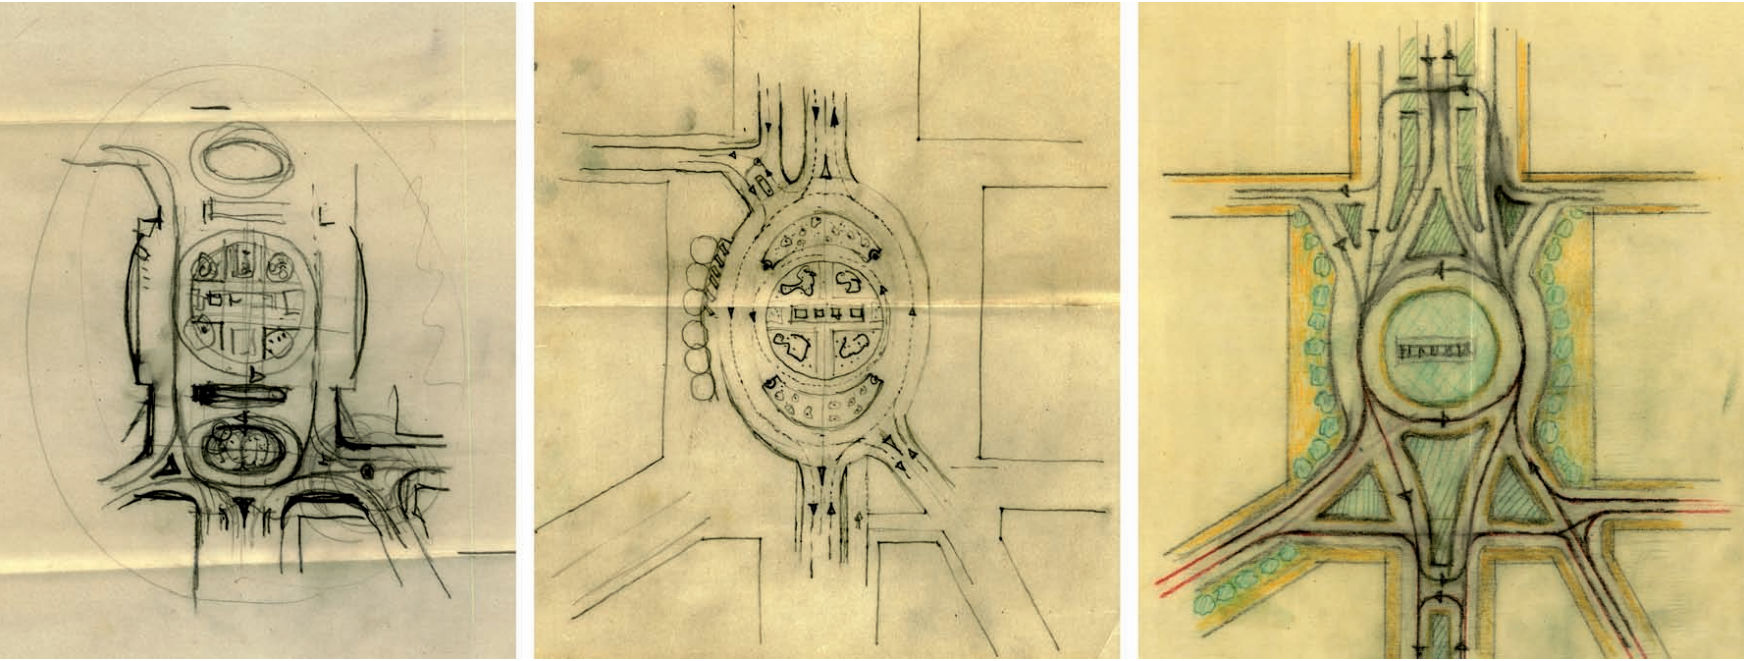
Plaza de Castilla (croquis preliminares). ca. 1947. Fuente: APAV.
